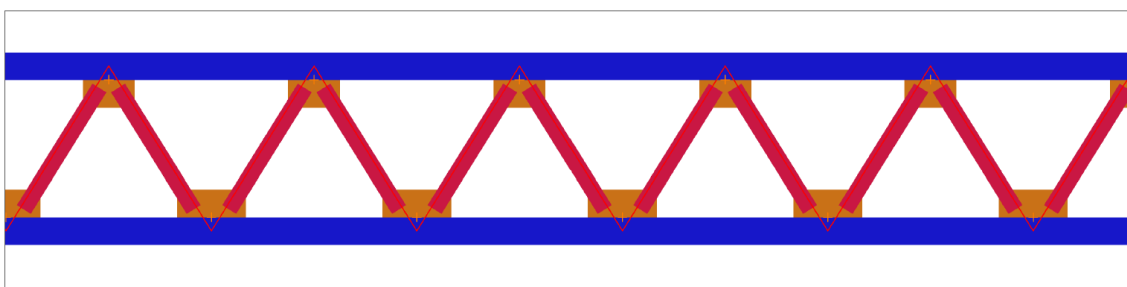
Ligações soldadas das diagonais e prumos aos gousset das vigas treliçadas.
